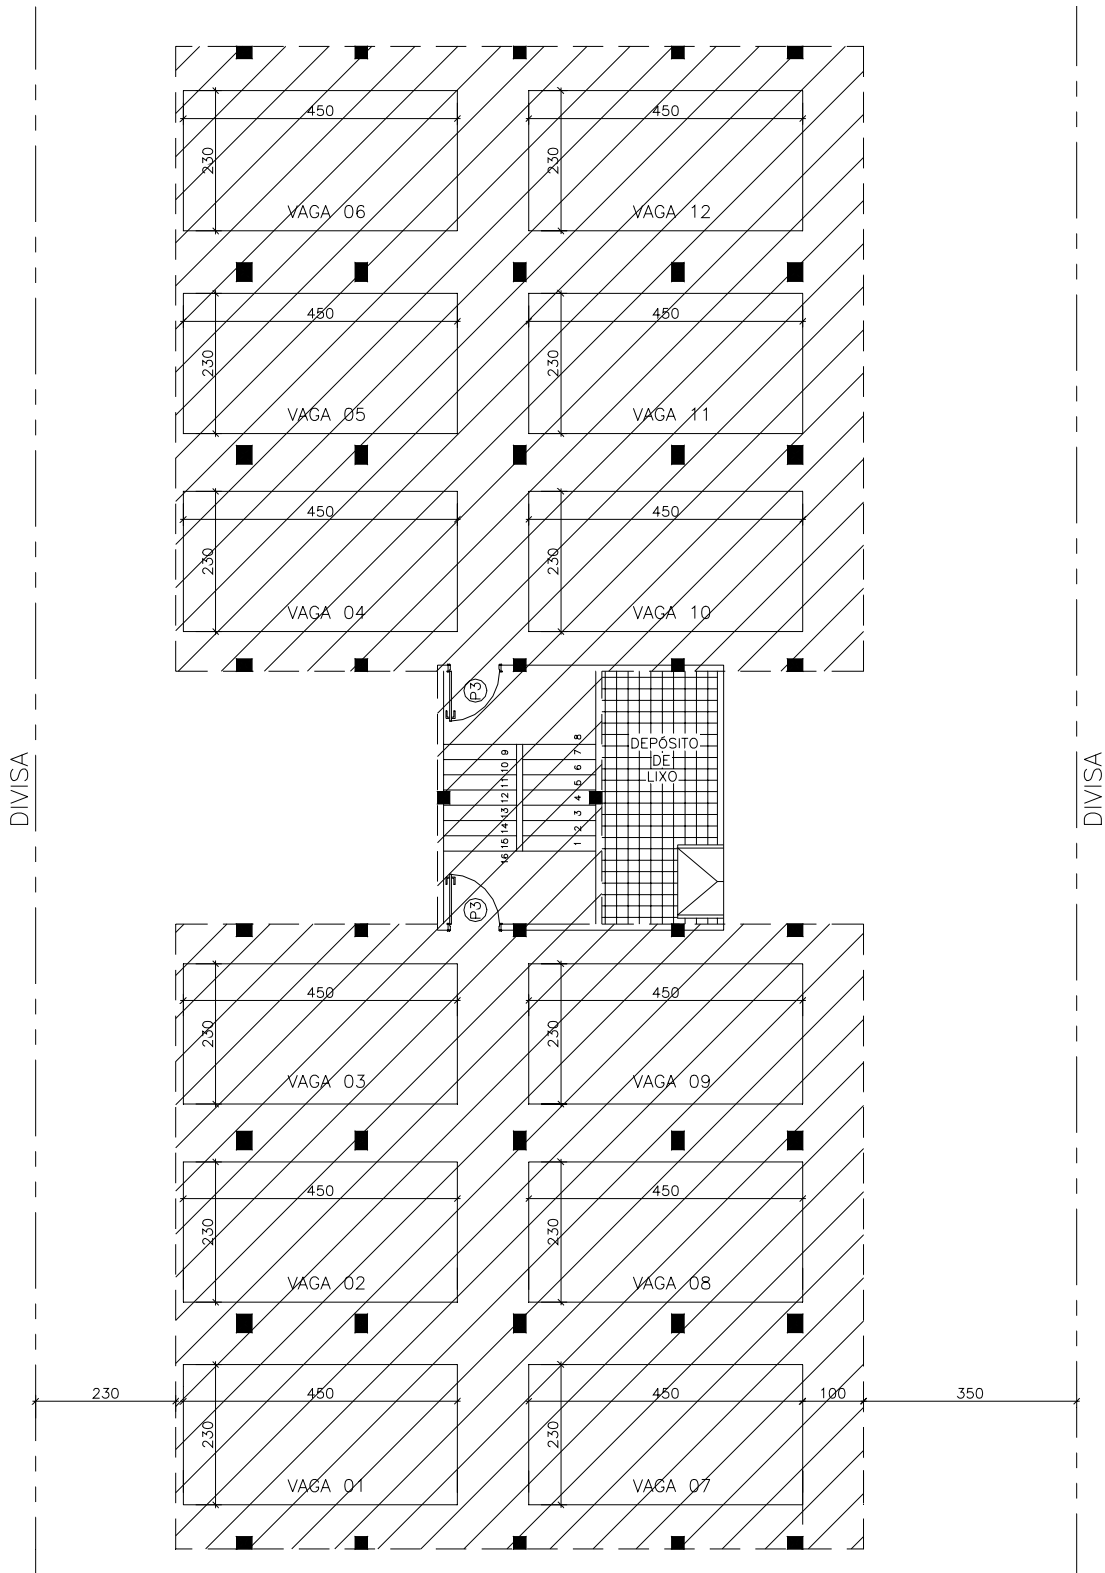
Residencial “G” – Projeção do pavimento tipo sobre as garagens
